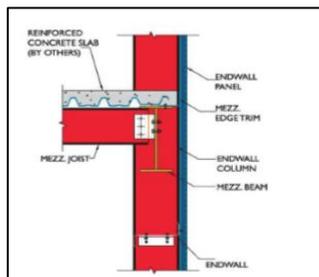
Assemblage poutre-panneau (Source: PRE-ENGINEERED BUILDING-pdf)
